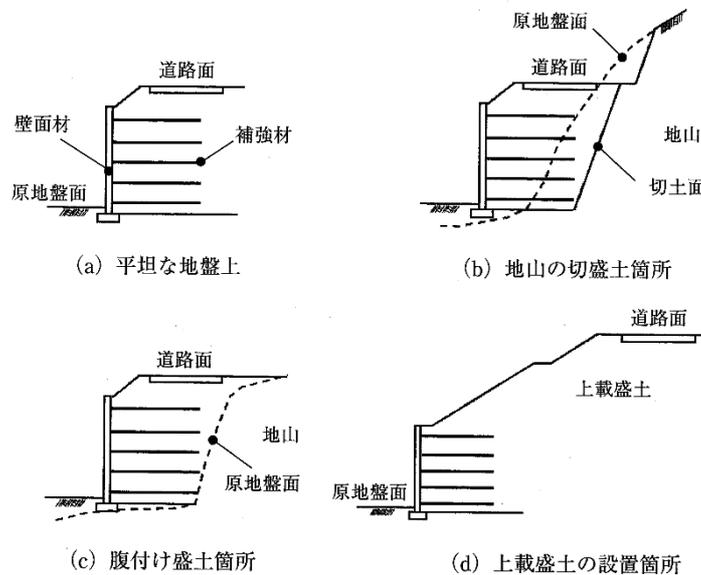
補強土壁の代表的な適用例⁸⁾
